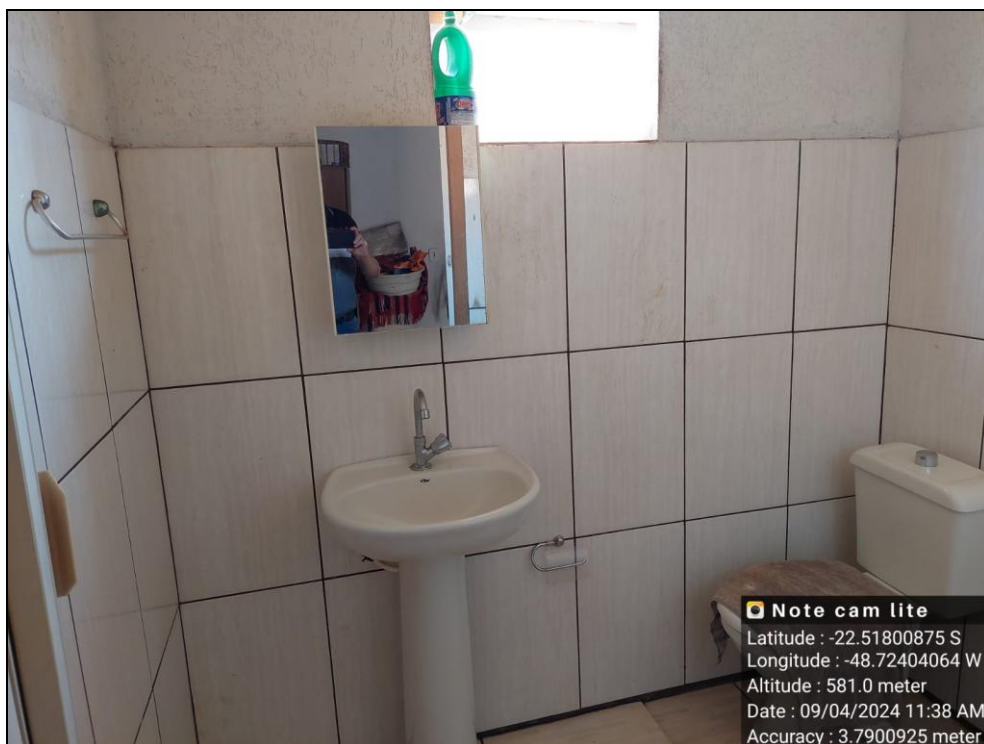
Detalhe do banheiro externo, localizado junto a lavanderia.
